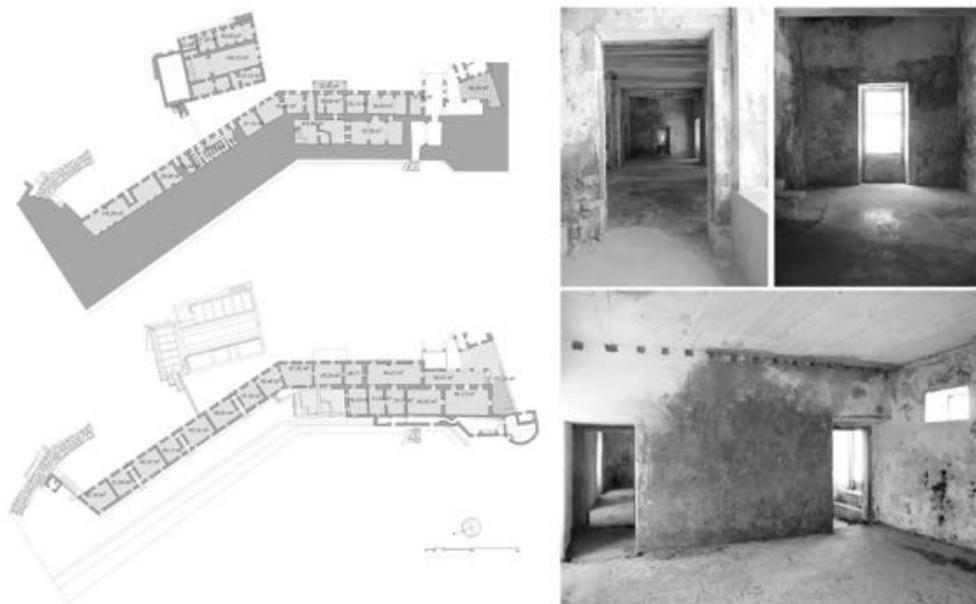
Levantamento dos lintéis de betão e de madeira. Piso superior.
